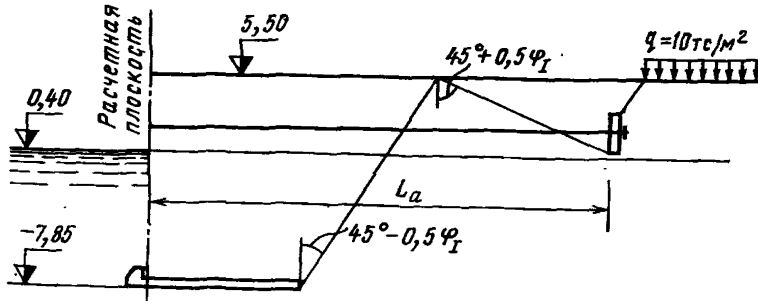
Схема к определению расстояния от лицевой стенки конструкции до анкерной плиты
